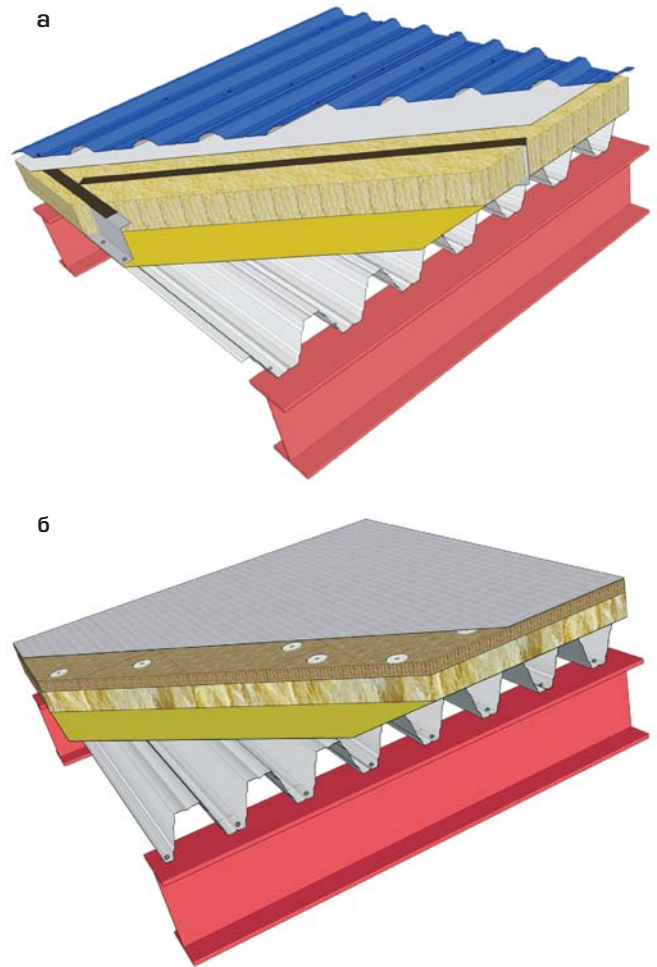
Жесткая (а) и мягкая (б) кровля в беспрогонной схеме
